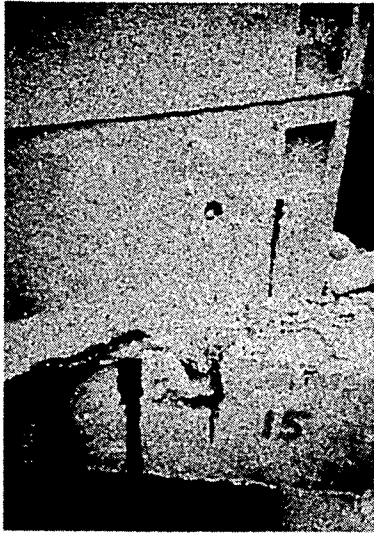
(左): 基礎と柱の接合部に貫通ひび割れが生じている。
